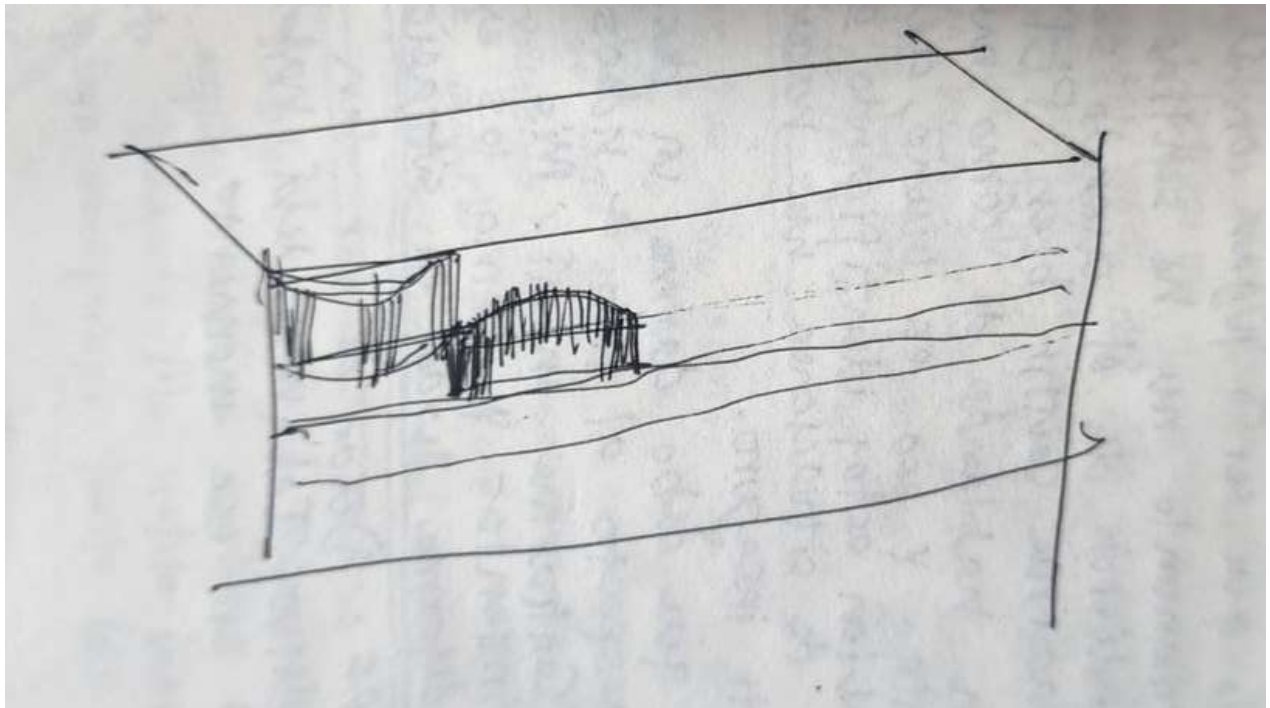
Proceso de diseño fachada. Fuente: Autoría propia.
